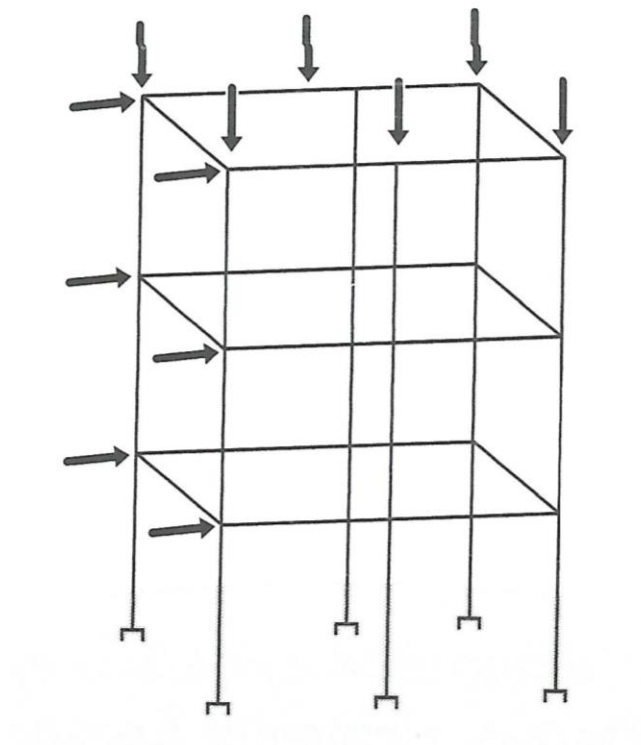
Pórtico espacial com cargas verticais e horizontais.
